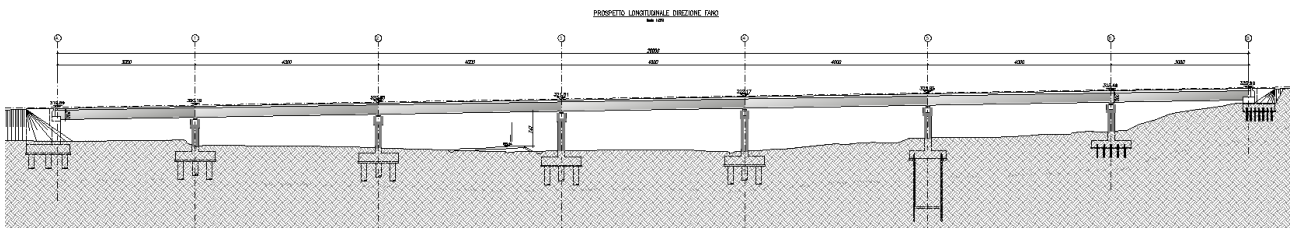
Profilo longitudinale carreggiata direzione Fano.
